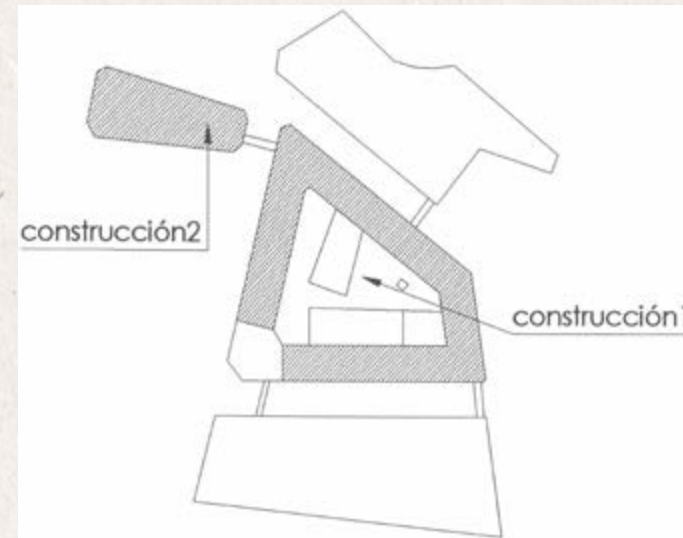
Nuevas construcciones edificadas en la fase 2 (1945-1960). Plano de Irene Moreno.
